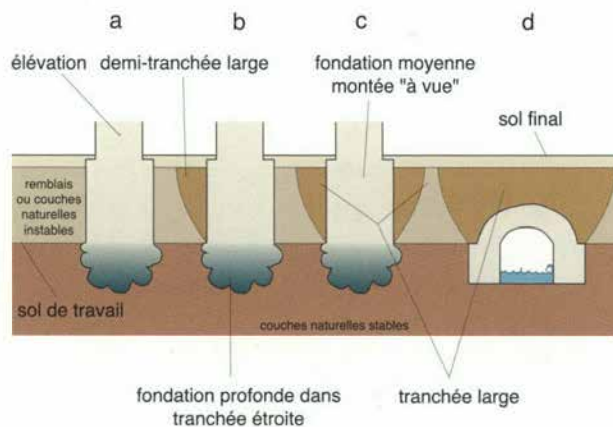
Les diverses techniques de construction des murs; a: mur construit avant la pose de remblais, directement à partir d'un sol naturel stable (sol de travail); b: mur construit dans des terrains peu stables (remblai ou terrain naturel) avant la pose du sol final; c: mur construit dans des terrains très instables avant la pose du sol final; d: canalisation construite dans des terrains très instables; si elle est construite avant la pose des remblais, la tranchée large (gris foncé) n'existe pas.
